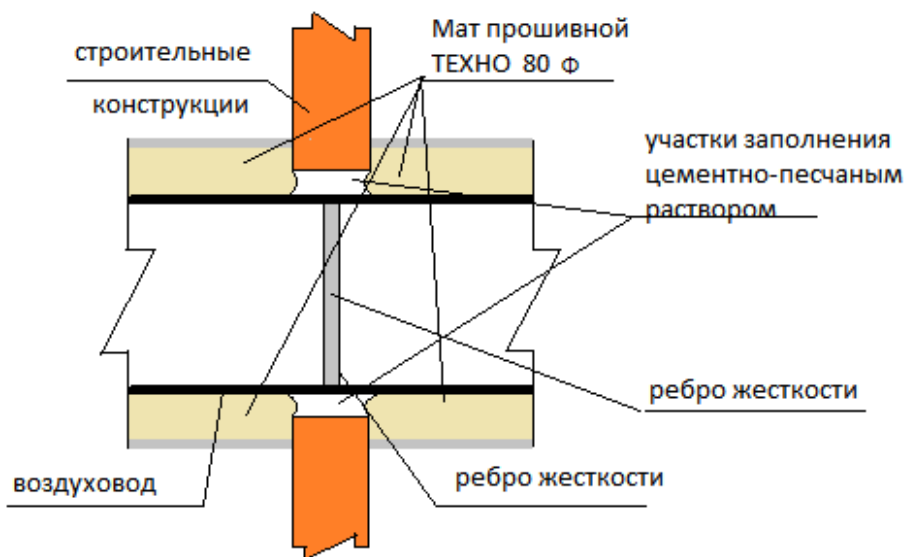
Принципиальная схема пересечения воздуховодом строительной конструкции
